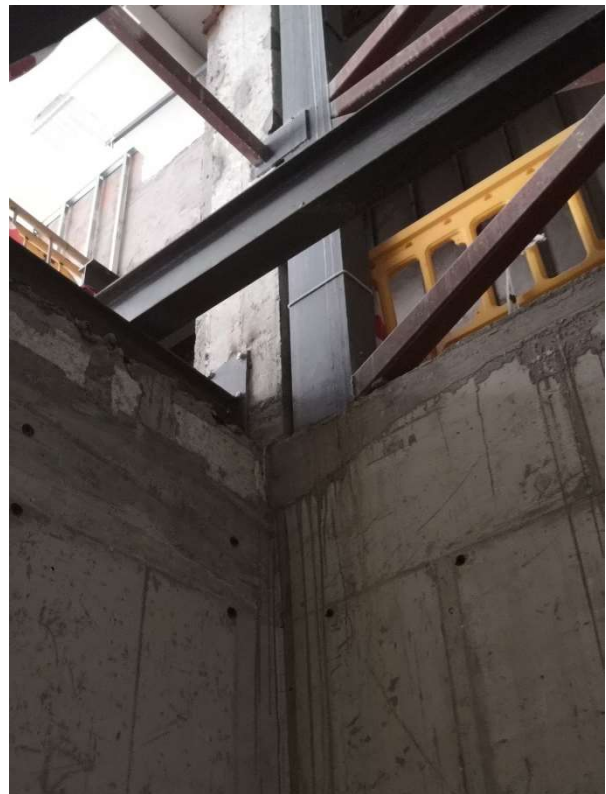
Muros del ascensor en sótano conectados al pilar de hormigón para transmisión de cargas.
